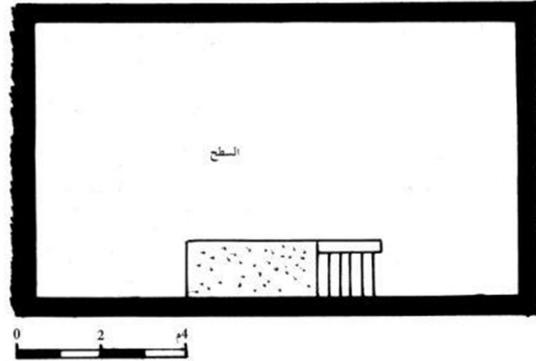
مسقط أفقي للطابق العلوي لنفس الدار
